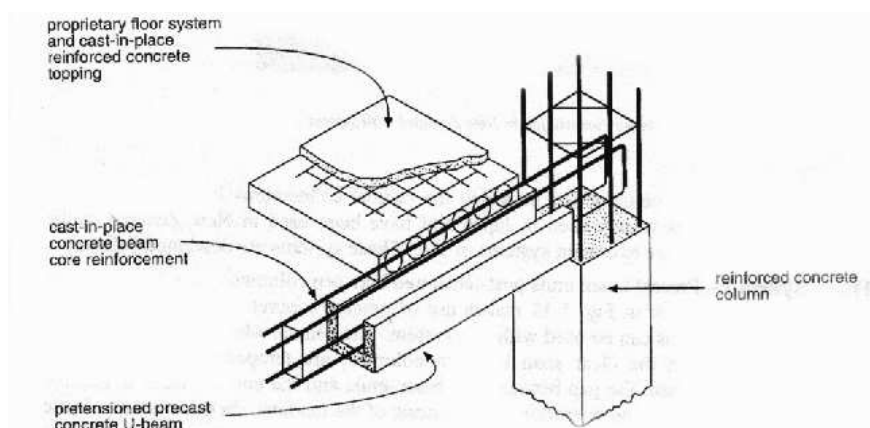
Sistema di collegamento ad emulazione del calcestruzzo gettato in opera – Soluzione progettuale n.11
